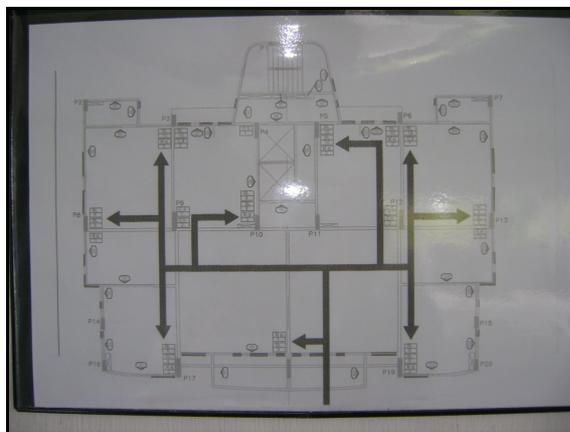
Planta de distribuição dos blocos no pavimento.
